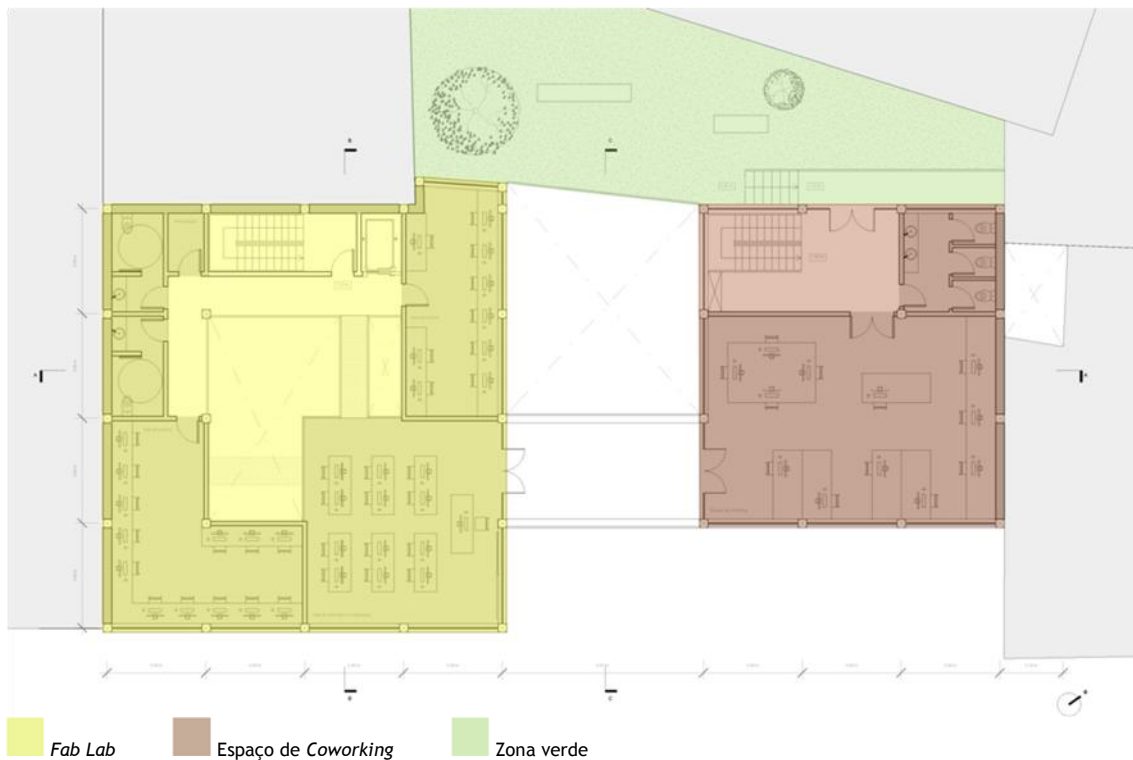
Fab Lab* e Espaço de *Coworking*, planta do piso 2. (Fonte: Autor)
